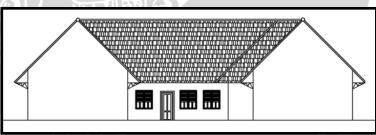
Site plan dan keadaan atap bangunan Gudang
